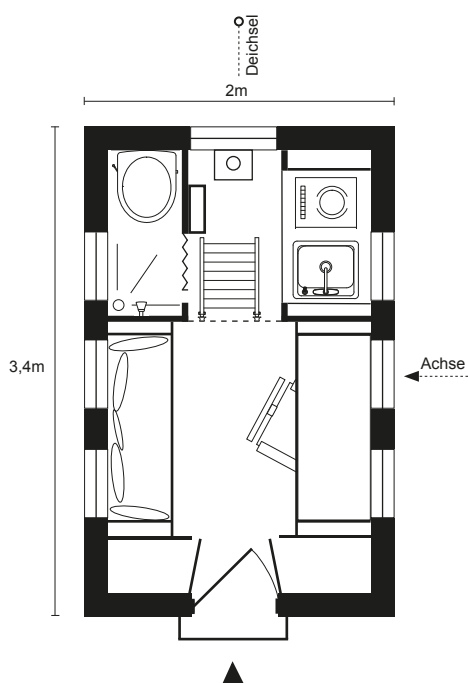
adaptierter Grundriss „XS-House“<sup>39</sup>
